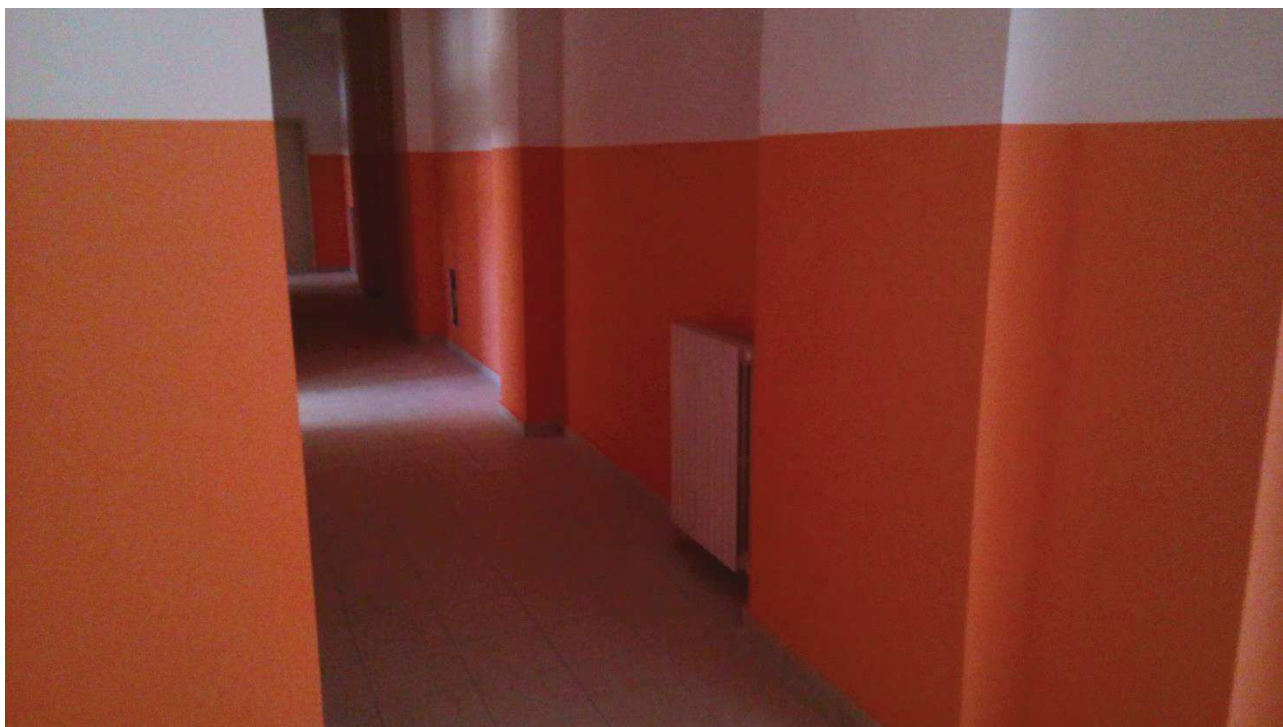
[Plesso Mancini] Situazione interna al corridoio palestra post operam.
